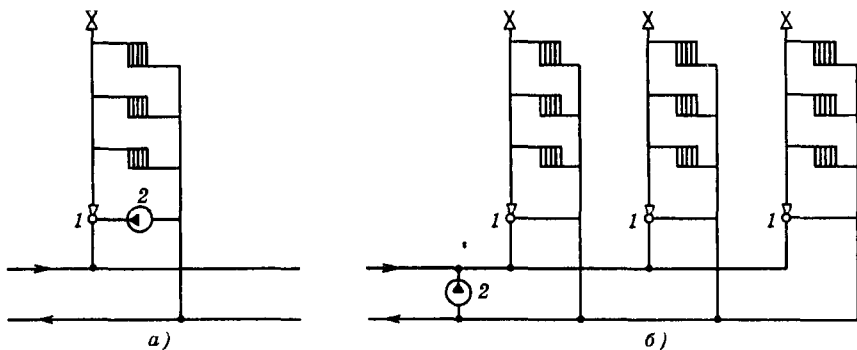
Схемы присоединения отопительных установок к тепловой сети
